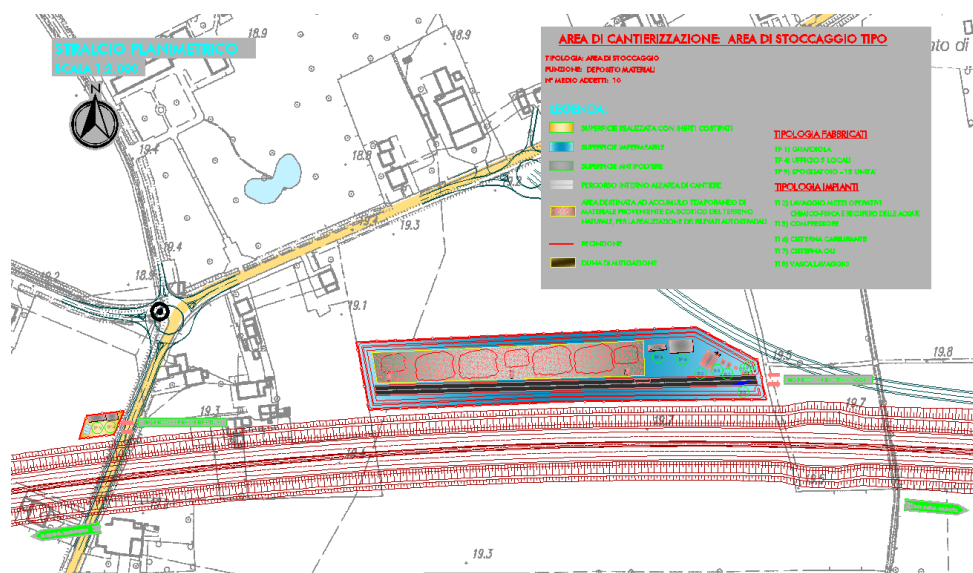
LAYOUT AREE DI CANTIERE OPERATIVE.
